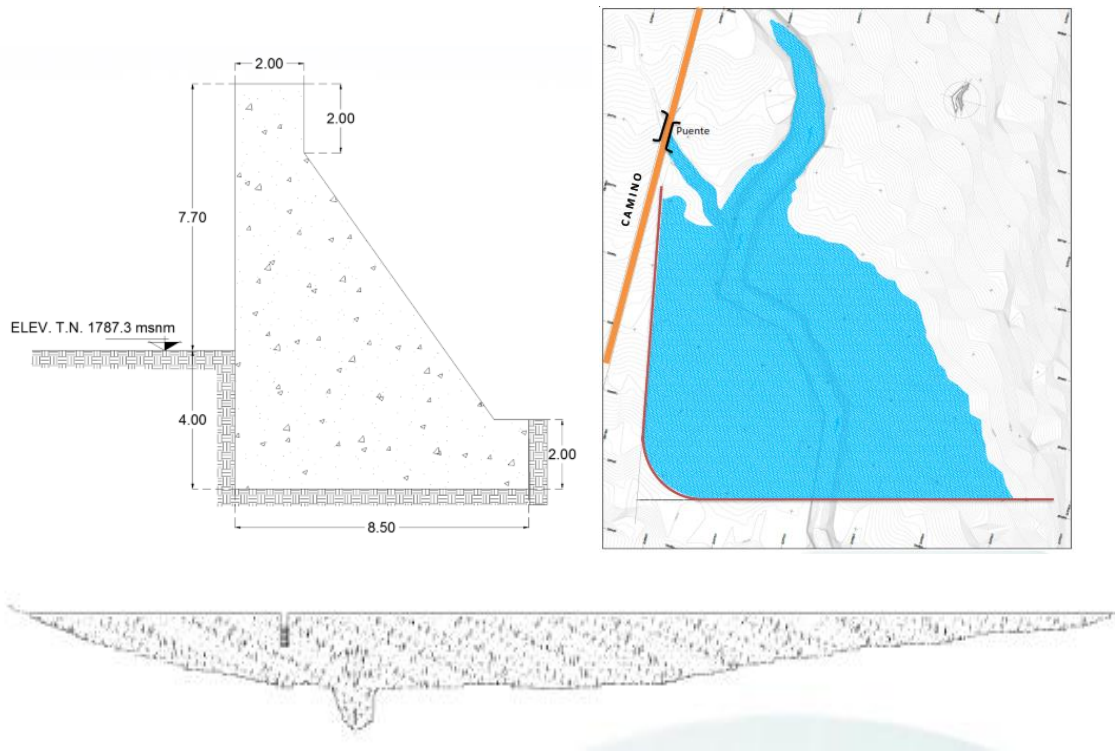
Lado izquierdo geometría general, lado derecho sección longitudinal presa Rompepicos Barrón y parte inferior alzado de la presa vista de aguas abajo hacia aguas arriba presa Barrón.
